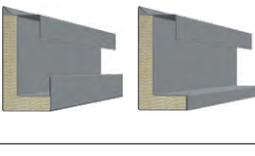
Montage des Lamellenlüfters in Maueröffnung (Wand, Fassade) von außen
